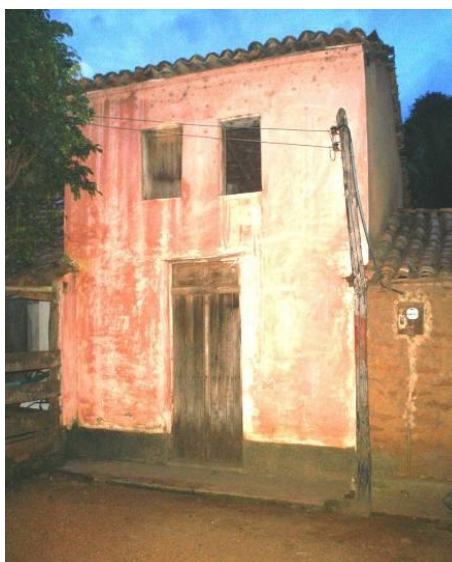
Vista da residência em adobe, com um quarto no pavimento superior.
